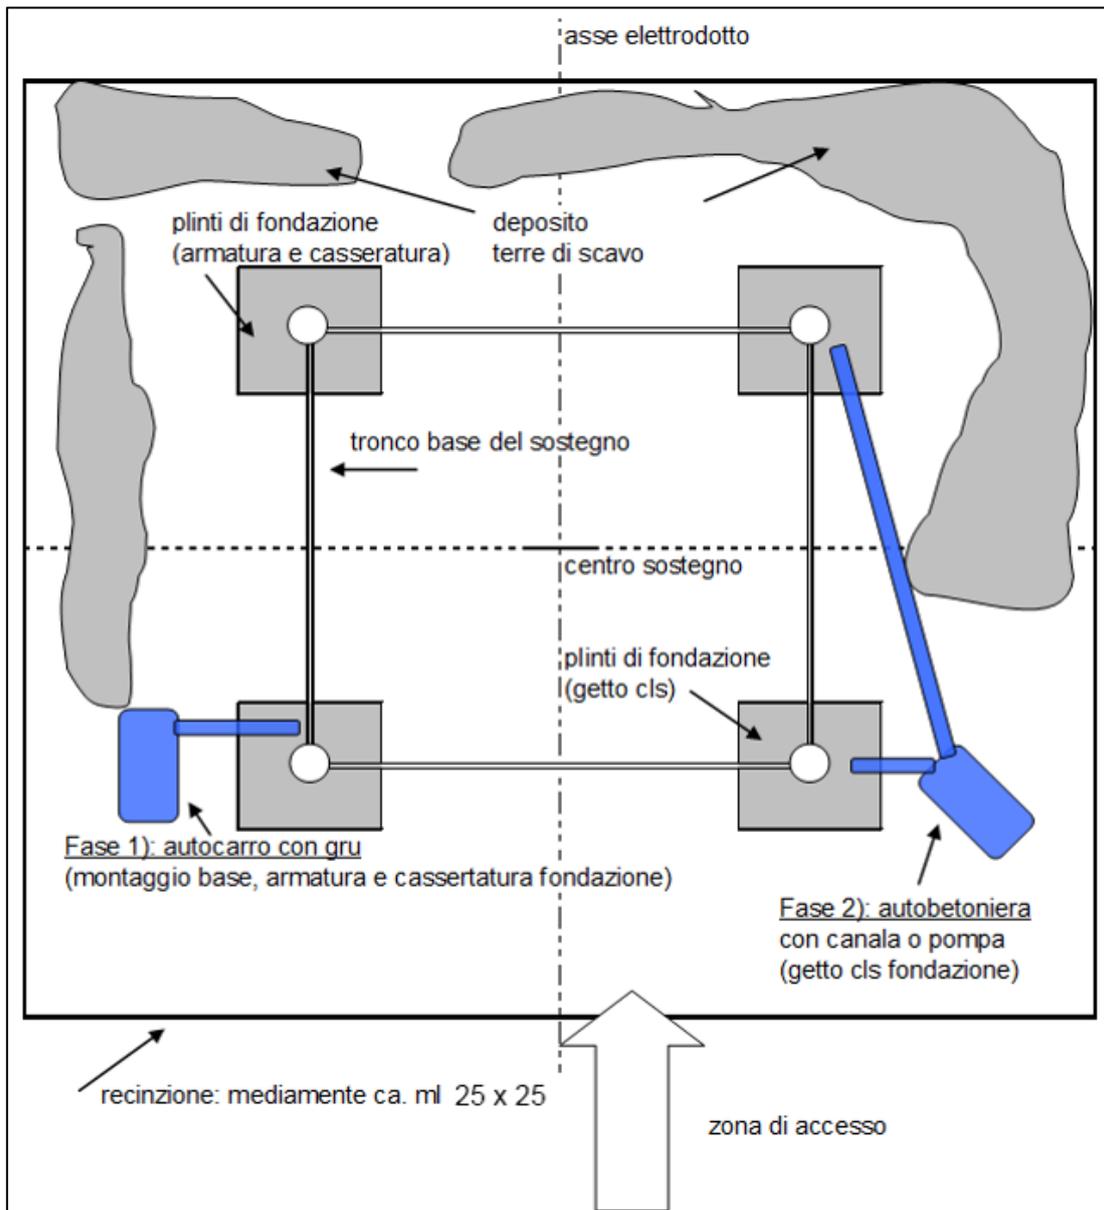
Layout tipo dell'area sostegno (getto e montaggio basi)
